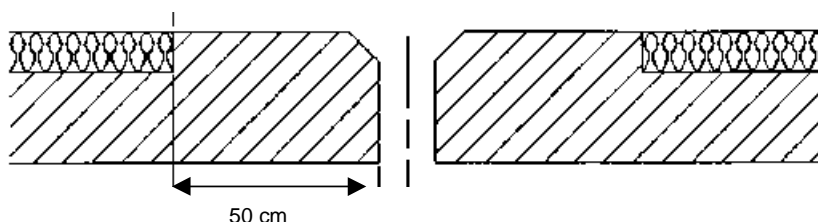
Butées en béton pour étanchéité de partie courante sur isolant non porteur
